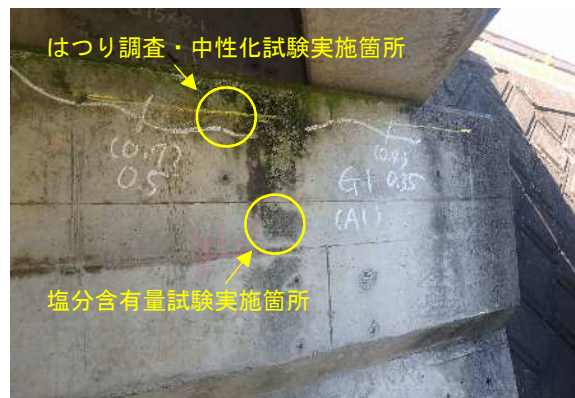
内部鉄筋に沿った水平ひびわれ (A1 橋台)
